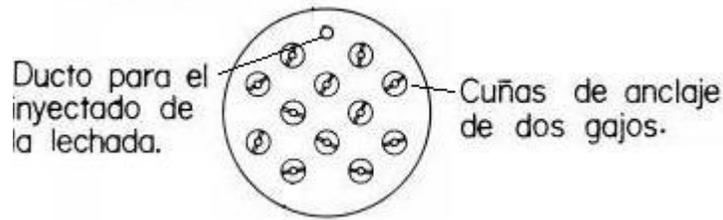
Arreglo de la placa de anclaje del sistema Gifford-Udall.
